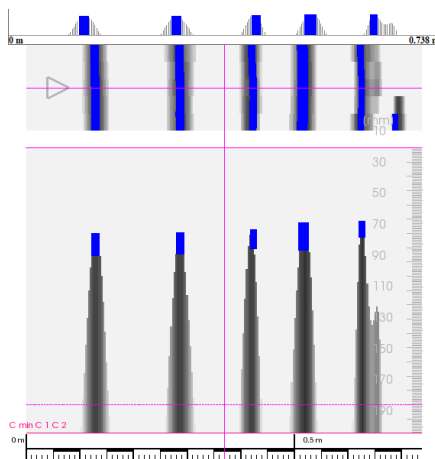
Poutre Pt05 – Travée 1 côté C0
